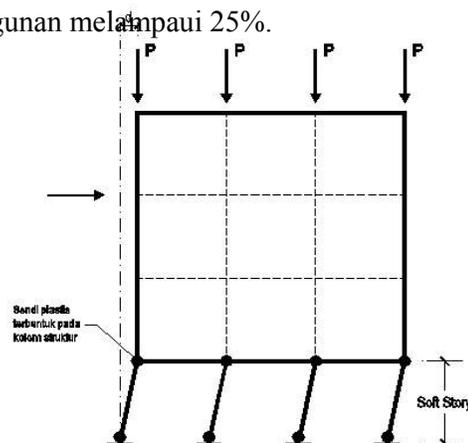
Soft storey* pada struktur bangunan akibat terputusnya kolom.
